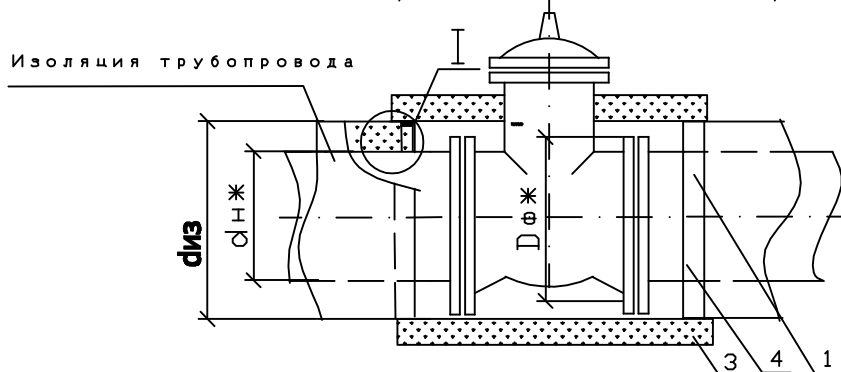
Крепление покрытия изоляции трубопроводов бандажами
